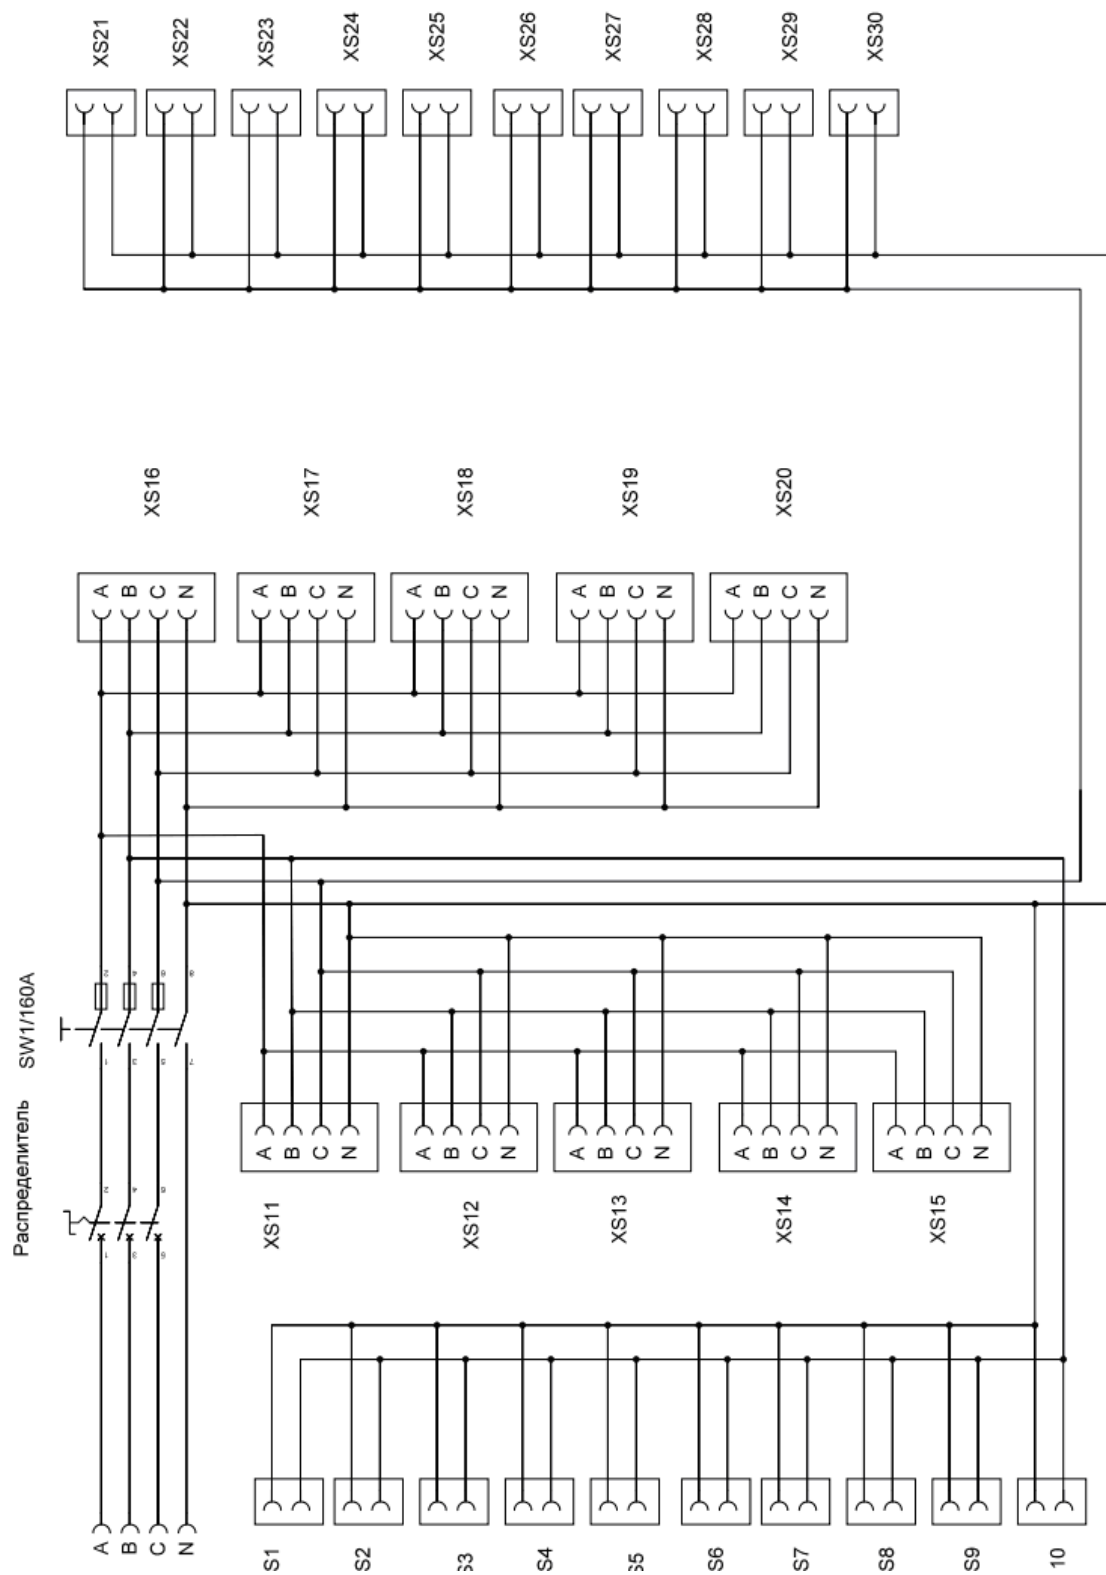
Схема проводки цеха сварки и пайки
